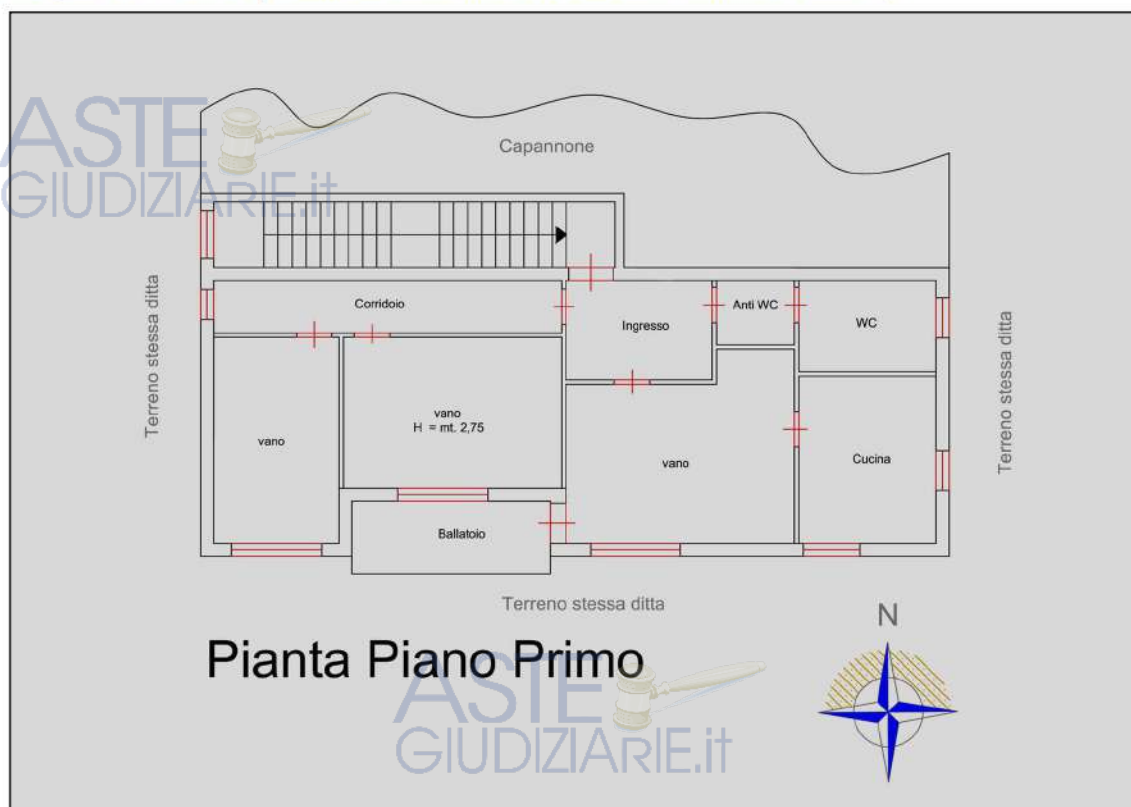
Visualizzazione della planimetria reale dell'immobile così come rilevata dal sottoscritto CTU
